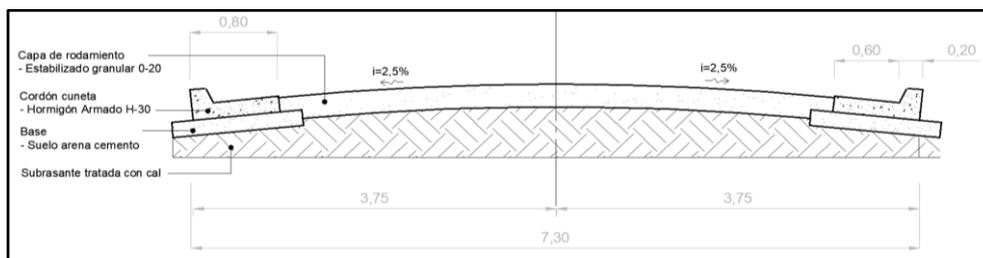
Sección transversal de los pavimentos proyectados.
